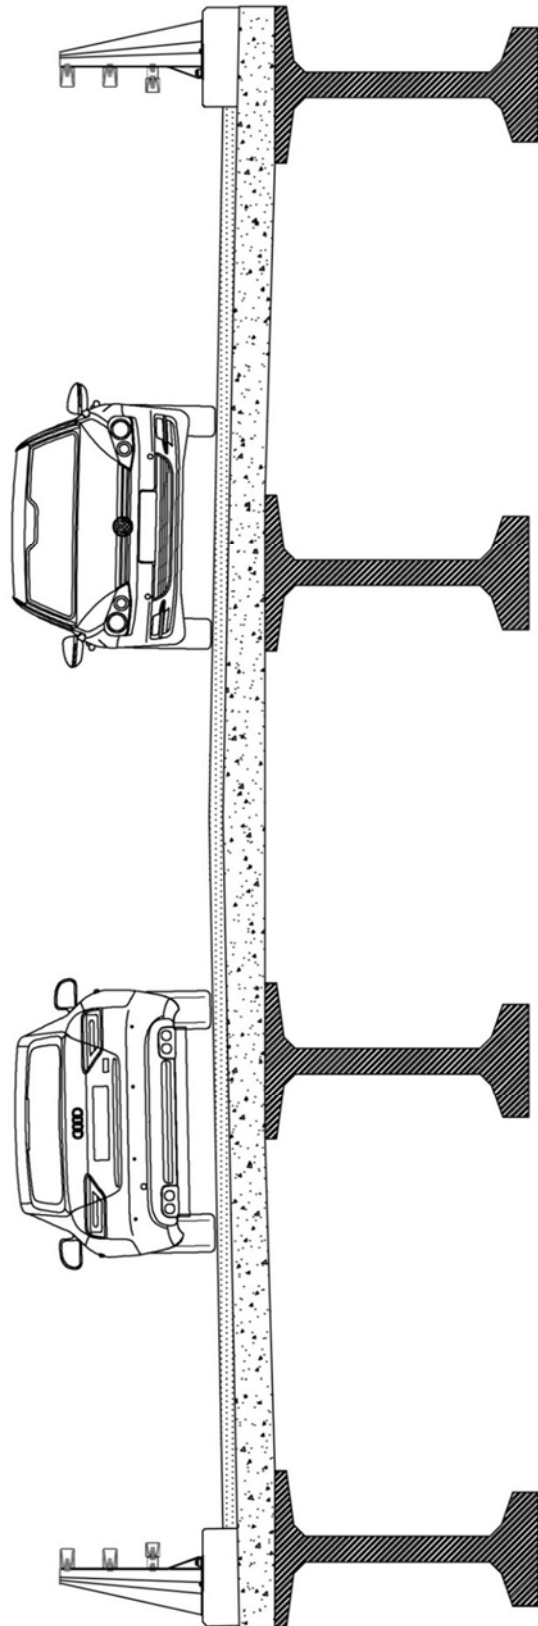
Sezione di un impalcato da ponte con struttura mista in calcestruzzo e acciaio su cui poggia l'impermeabilizzazione carrabile in conglomerato polimerico
